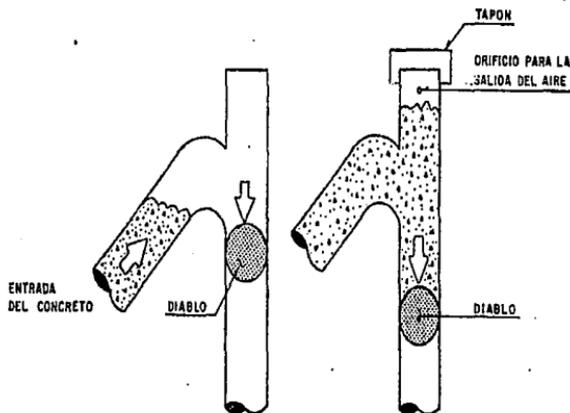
Dispositivo para la colocación del tapón deslizando para colados por bombeo de concreto
